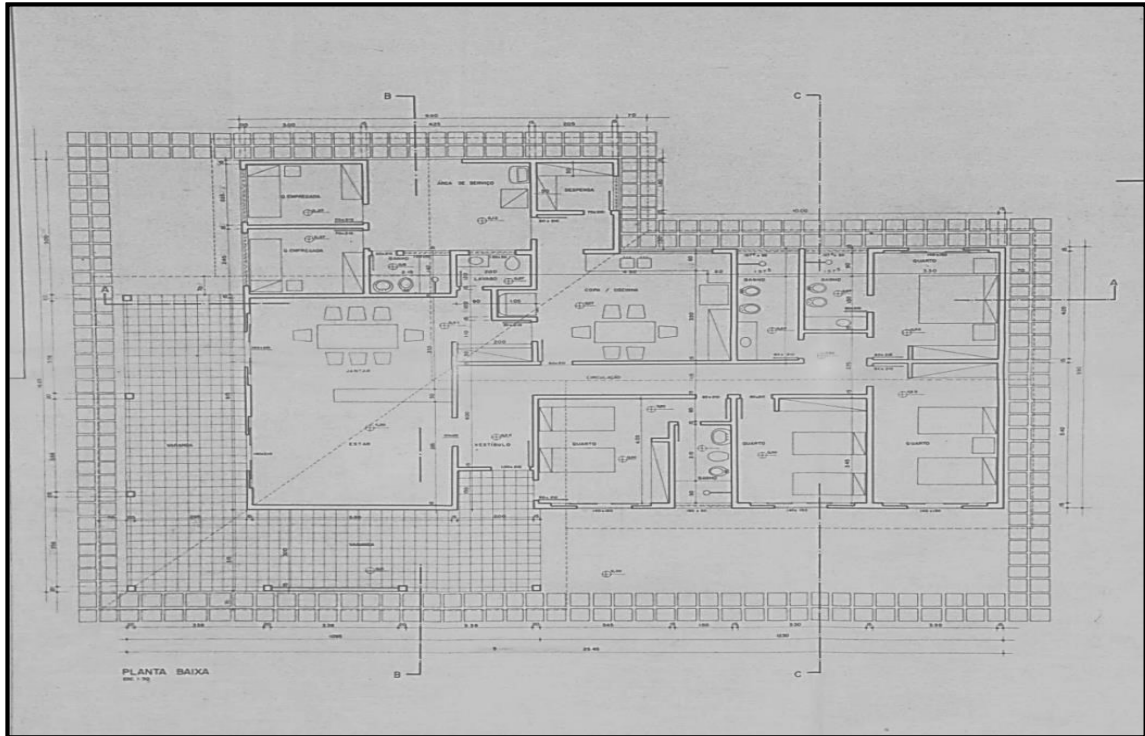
Planta baixa da casa do diretor da EAFUR
